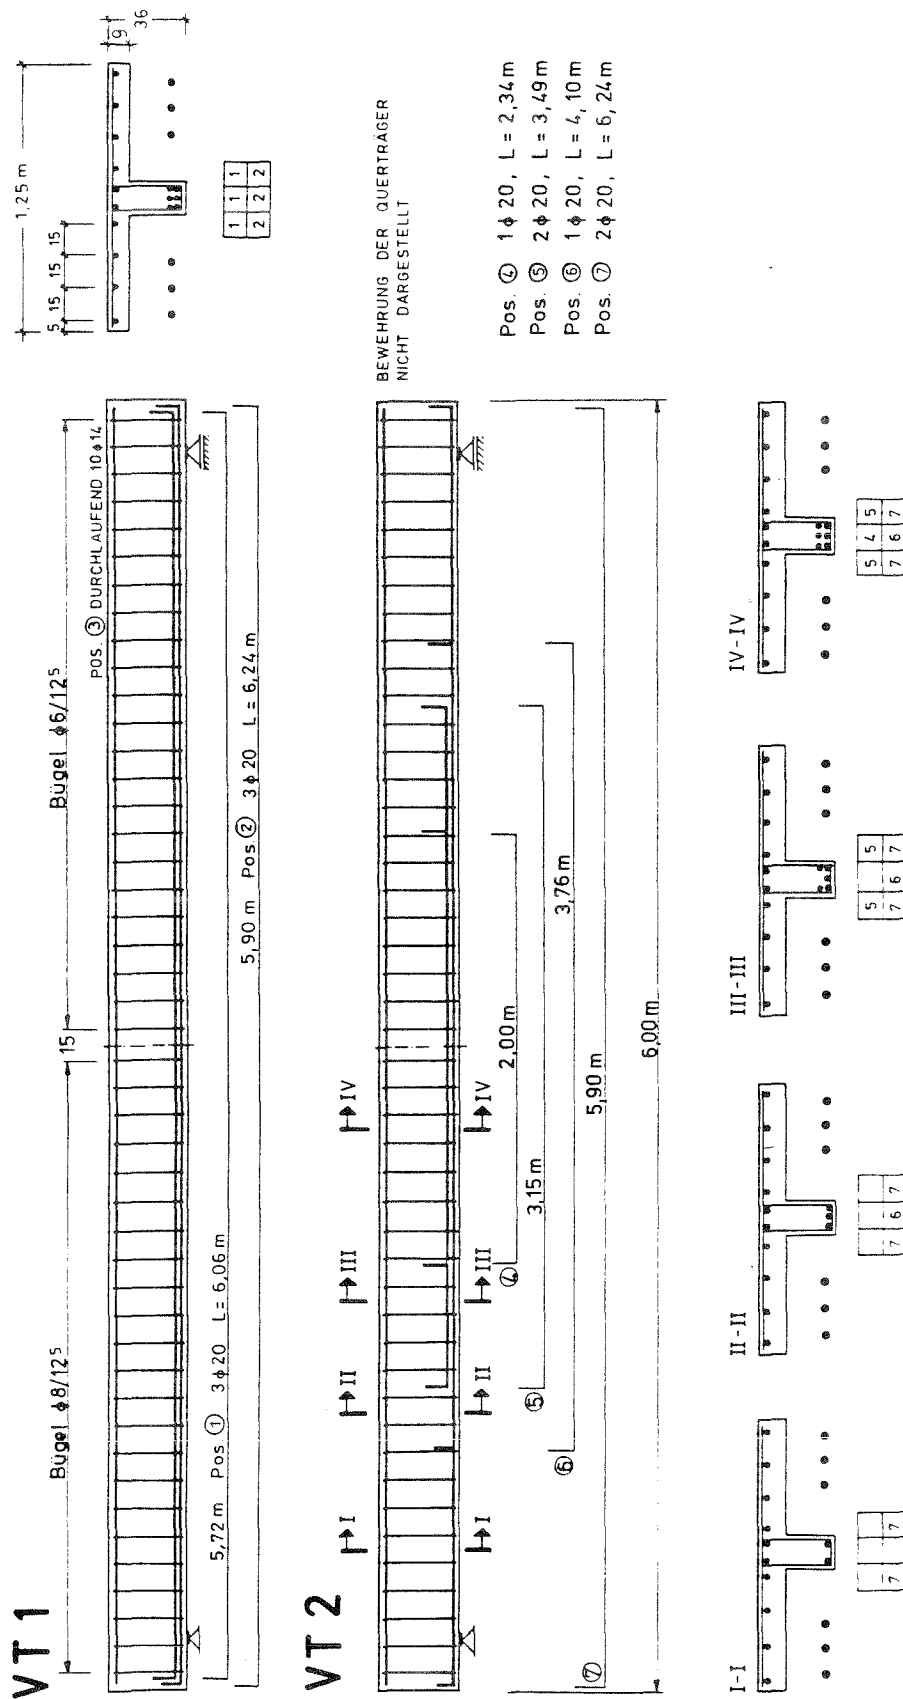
Betonstahlbewehrung VT 1 und VT 2
